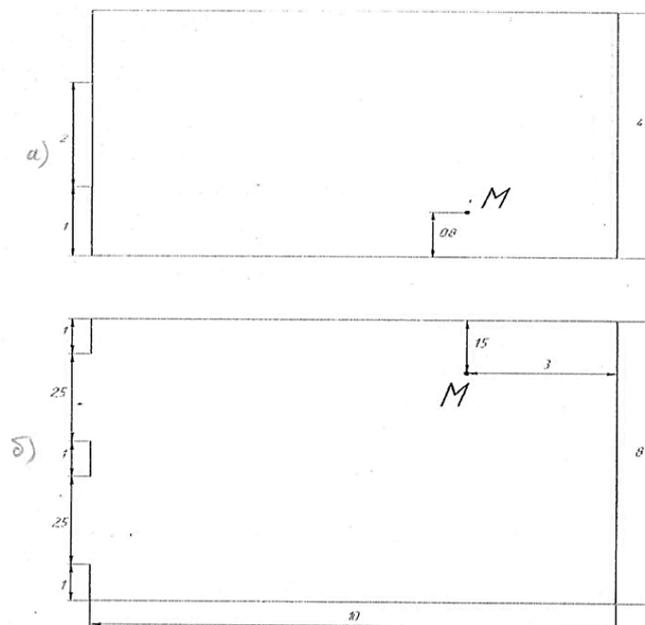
Схема помещения: а – поперечный разрез; б – план
